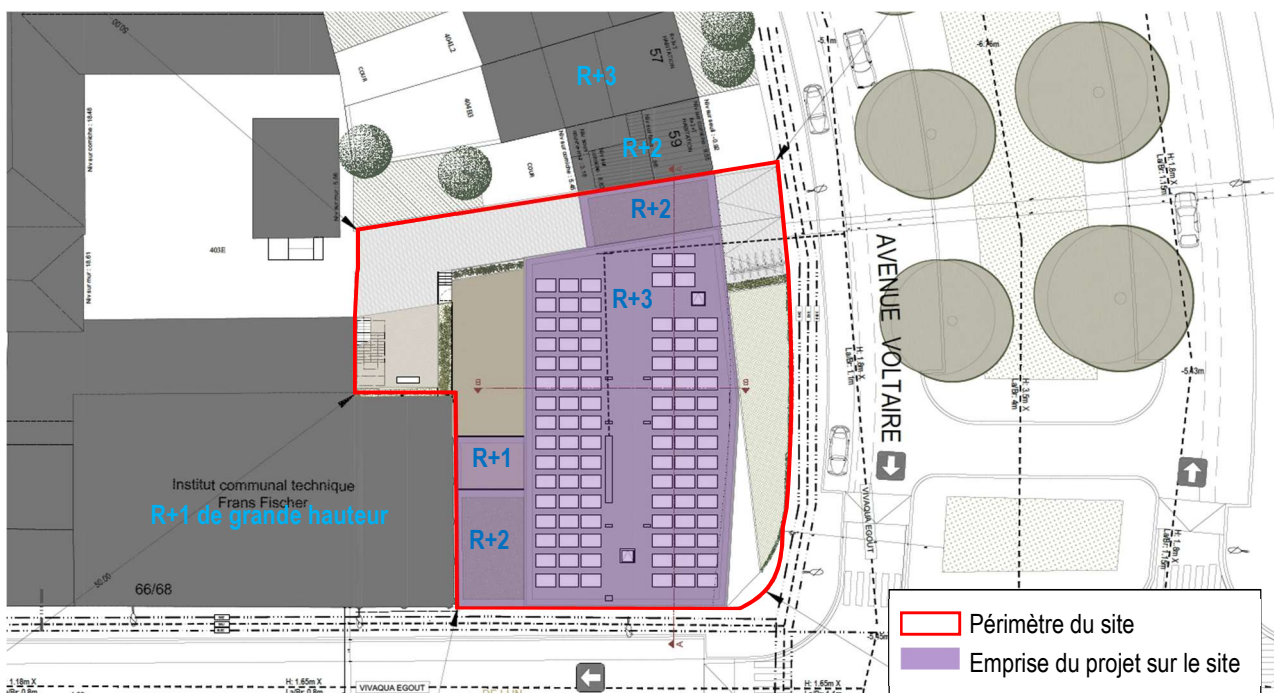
Implantation du projet en plan (ARIES sur fond R²D², 2017)
